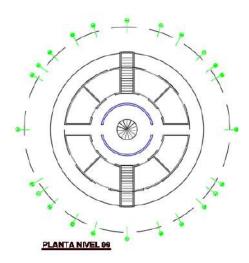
Planta del noveno nivel. (Fuente Autor)
